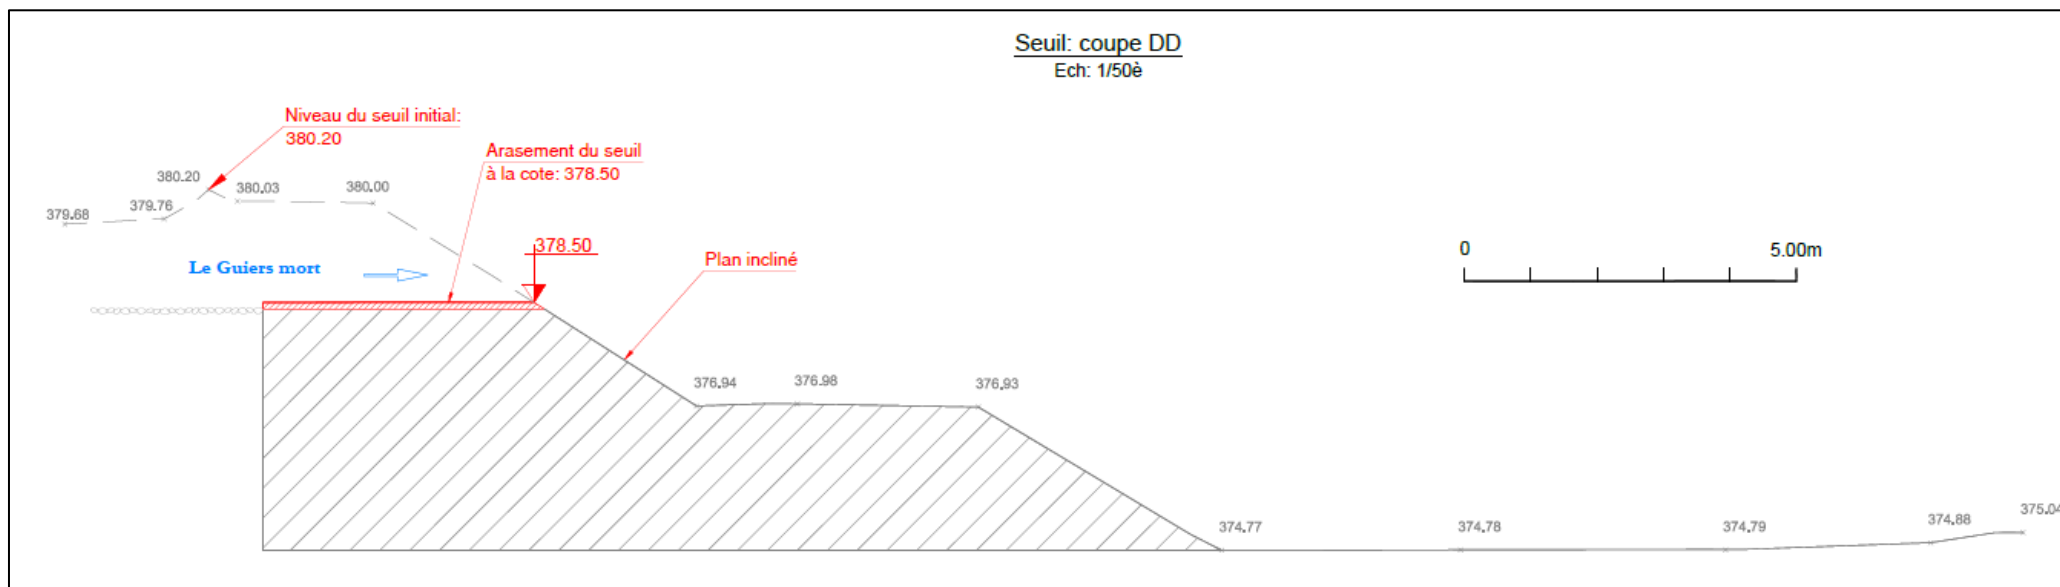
Coupe longitudinale – Profil en long - du seuil du Moulin Neuf arasé et de la passe à Canôë
